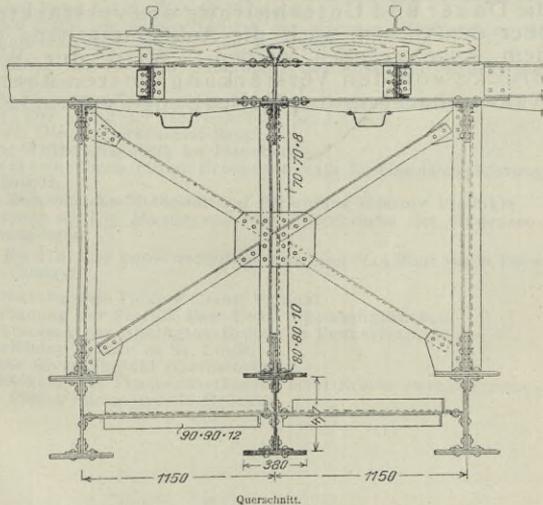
Verstärkung der Brücke zu Abb. 687 durch Vermehrung der Hauptträgerzahl. Nach Labes, Verstärkung eiserner Brücken.
